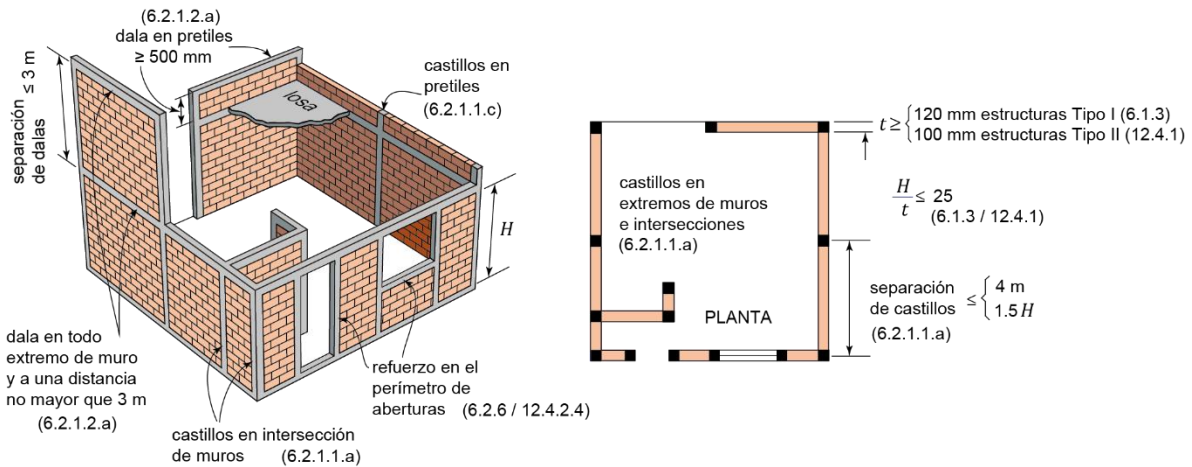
a – Requisitos para mampostería confinada
